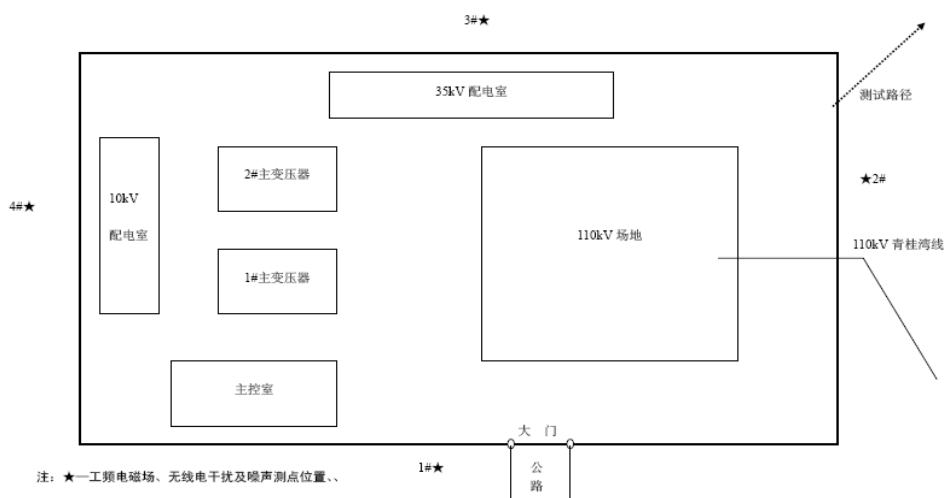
类比大弯 110kV 变电站站区总平面布置及监测点布置图
